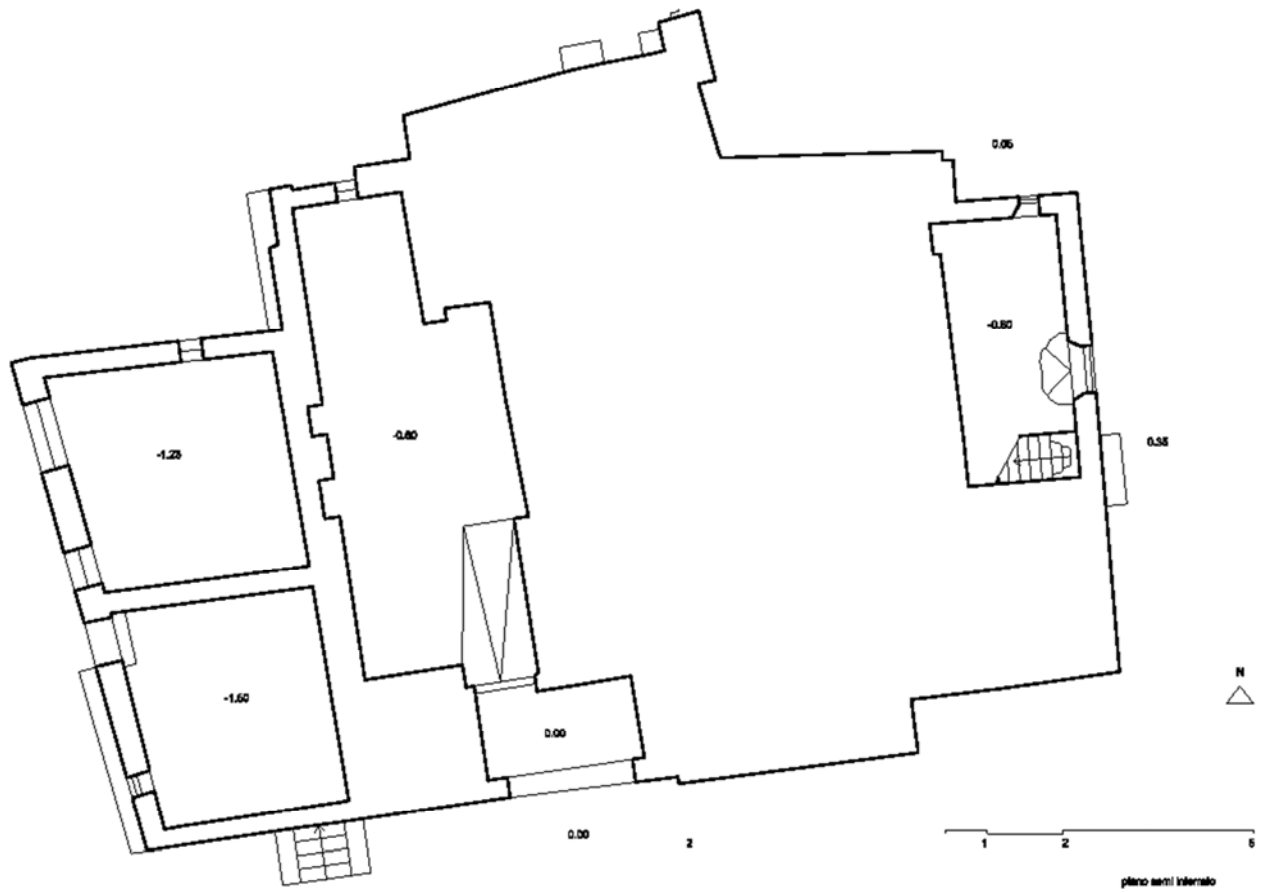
Planimetria piano seminterrato. Scala 1:200
